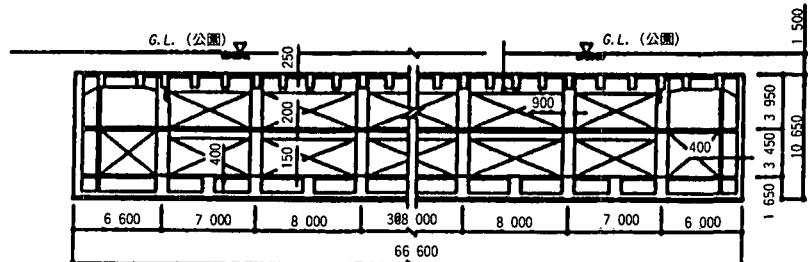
三宮第2駐車場断面図（断面B-B）
